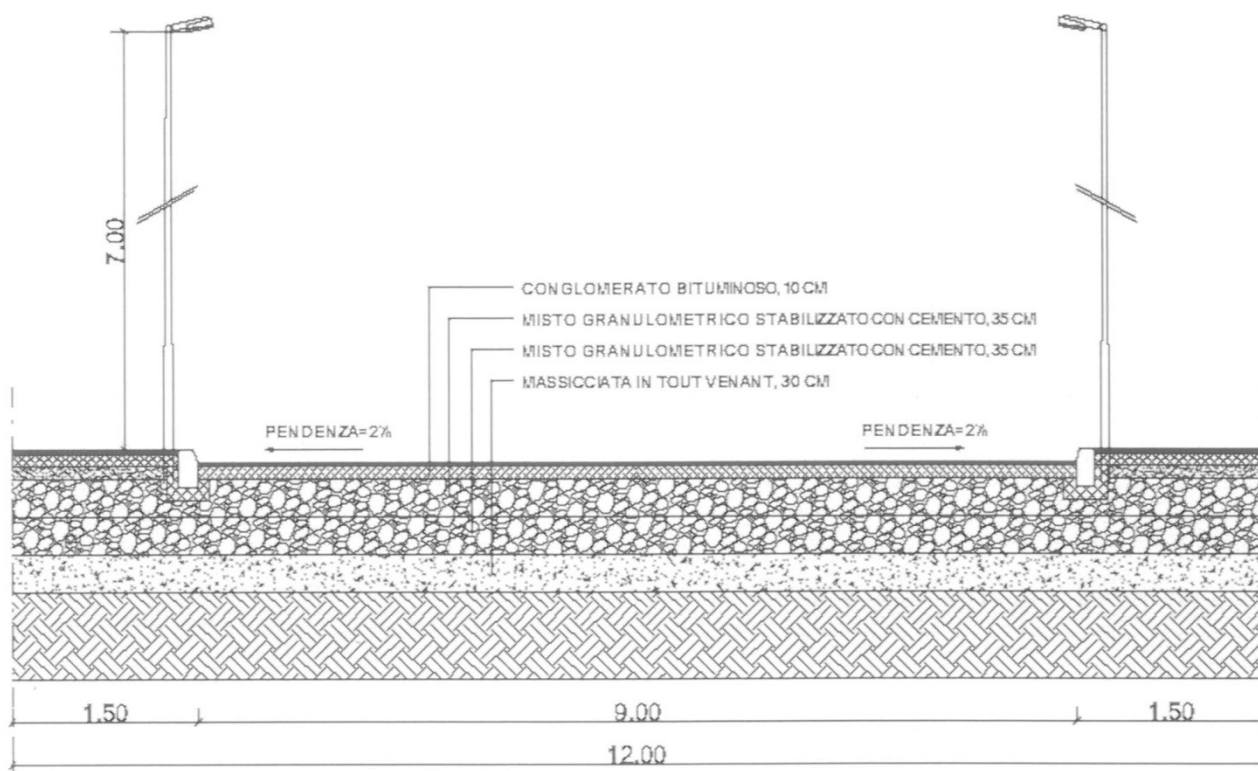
SEZIONE VERTICALE DELLA STRATIGRAFIA DELLA SEDE STRADALE PRIMA DELL'INTERVENTO
